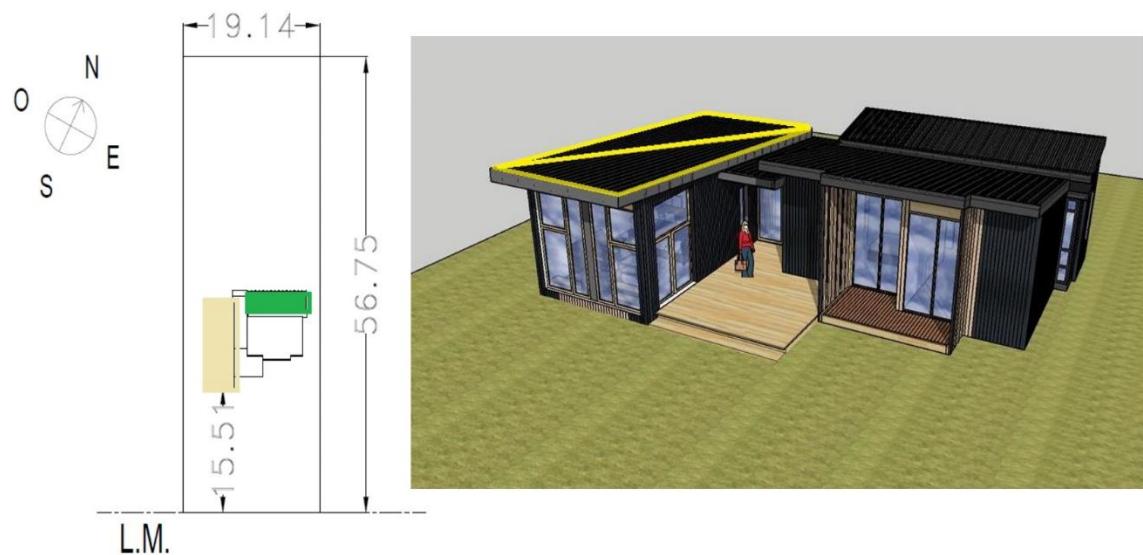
Proyecto Playa - Vivienda Tipo-Distribución Techos
